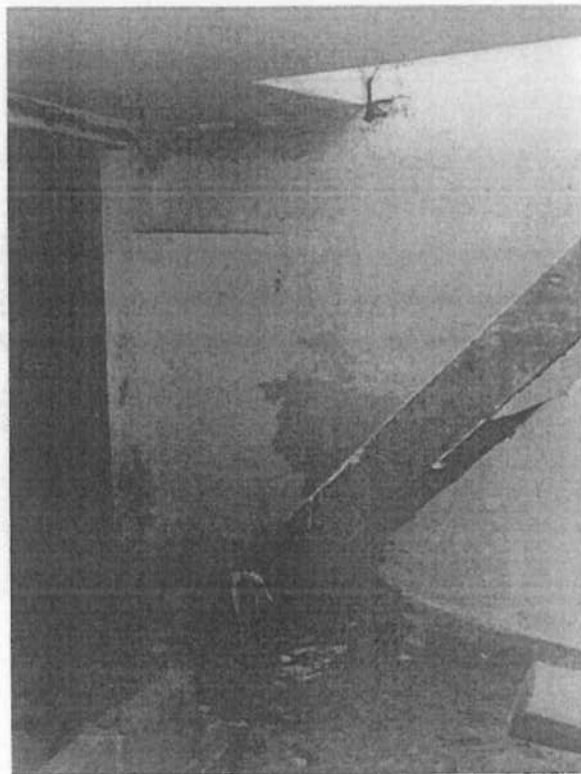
Scala in legno di collegamento tra il piano primo e il piano secondo.
